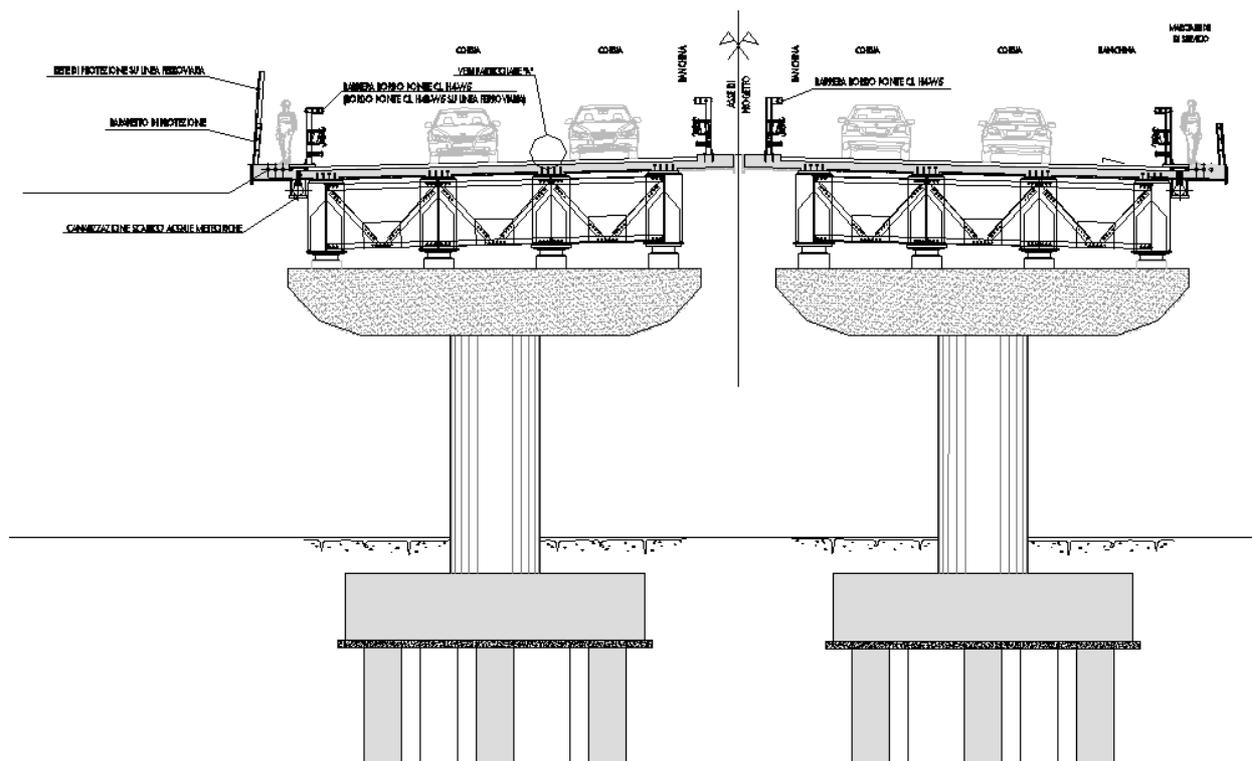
Sezione trasversale tipica impalcati
